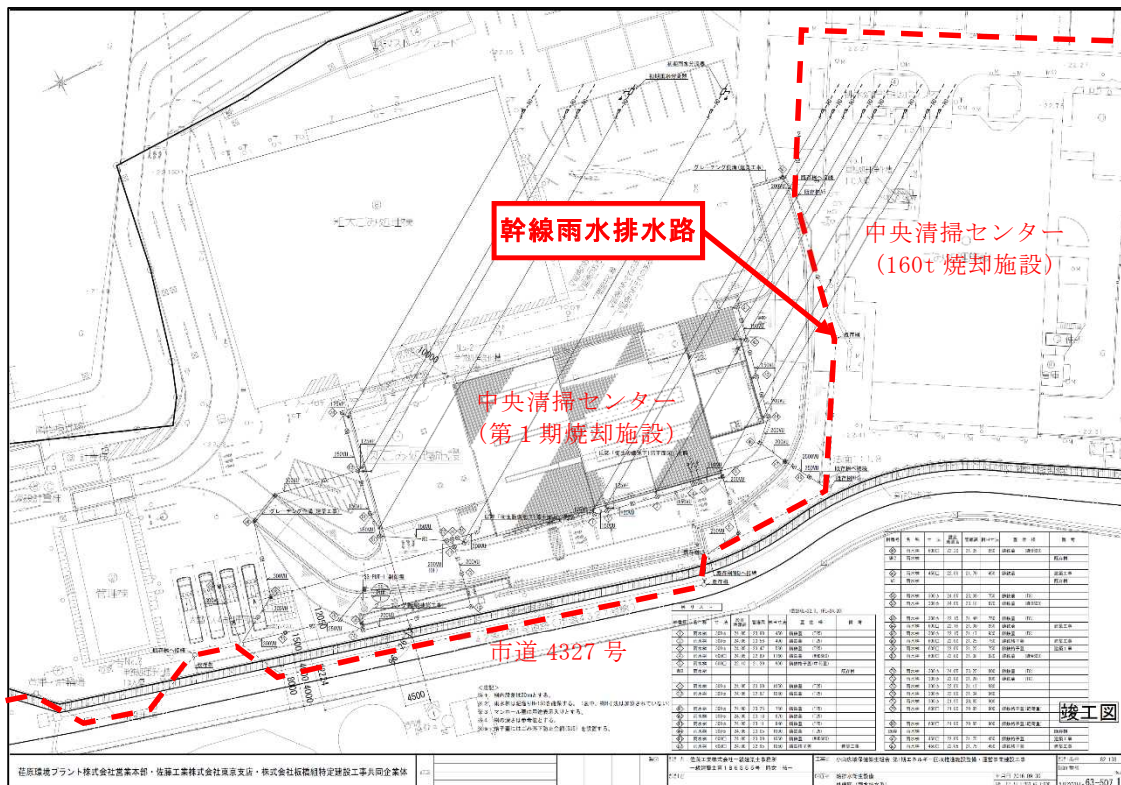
幹線雨水排水路の配置図（第1期焼却施設整備時）
